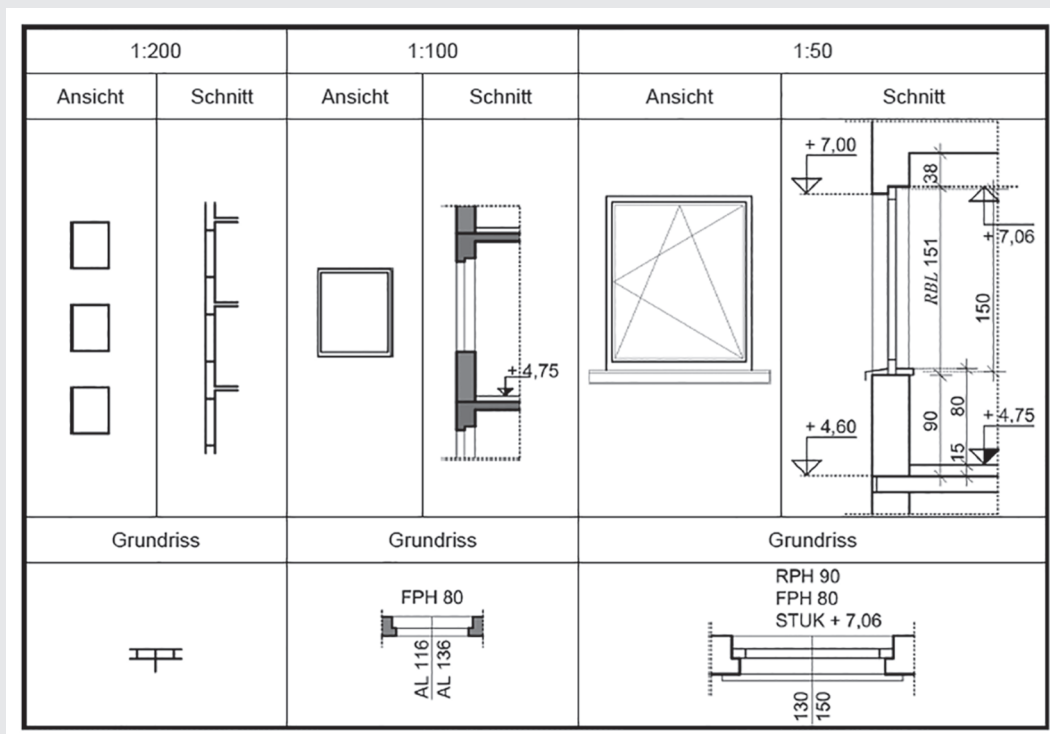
ÖNORM A 6240-2: Beispiel für die Darstellung von Fenstern in Grundriss, Ansicht und Schnitt
